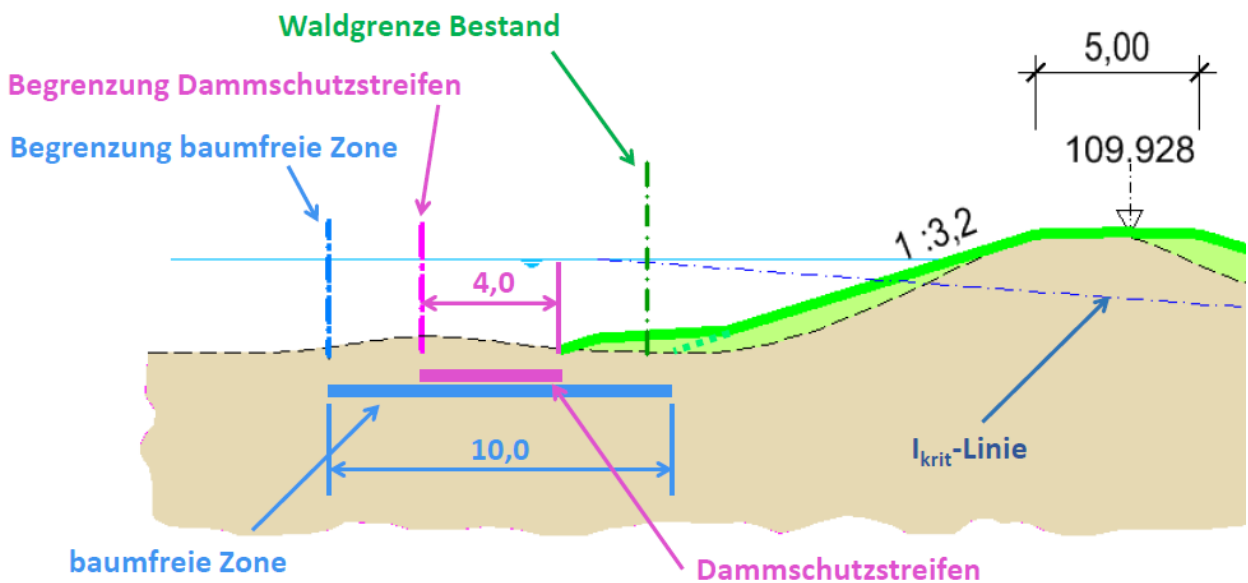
Detaildarstellung Berücksichtigung baumfreie Zone mit Berme
